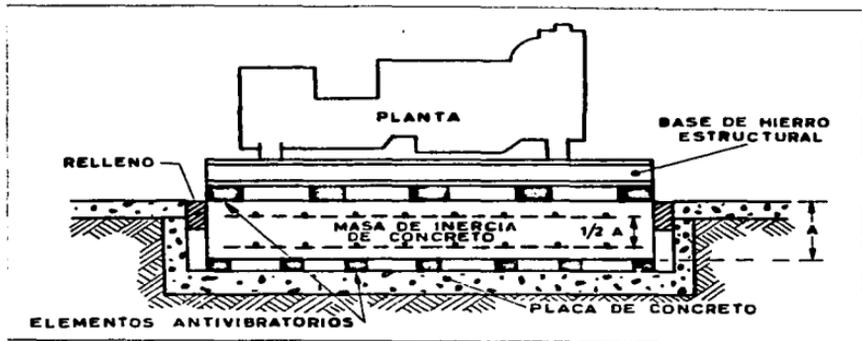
Cimentación de una planta eléctrica con elemento antivibratorios.
